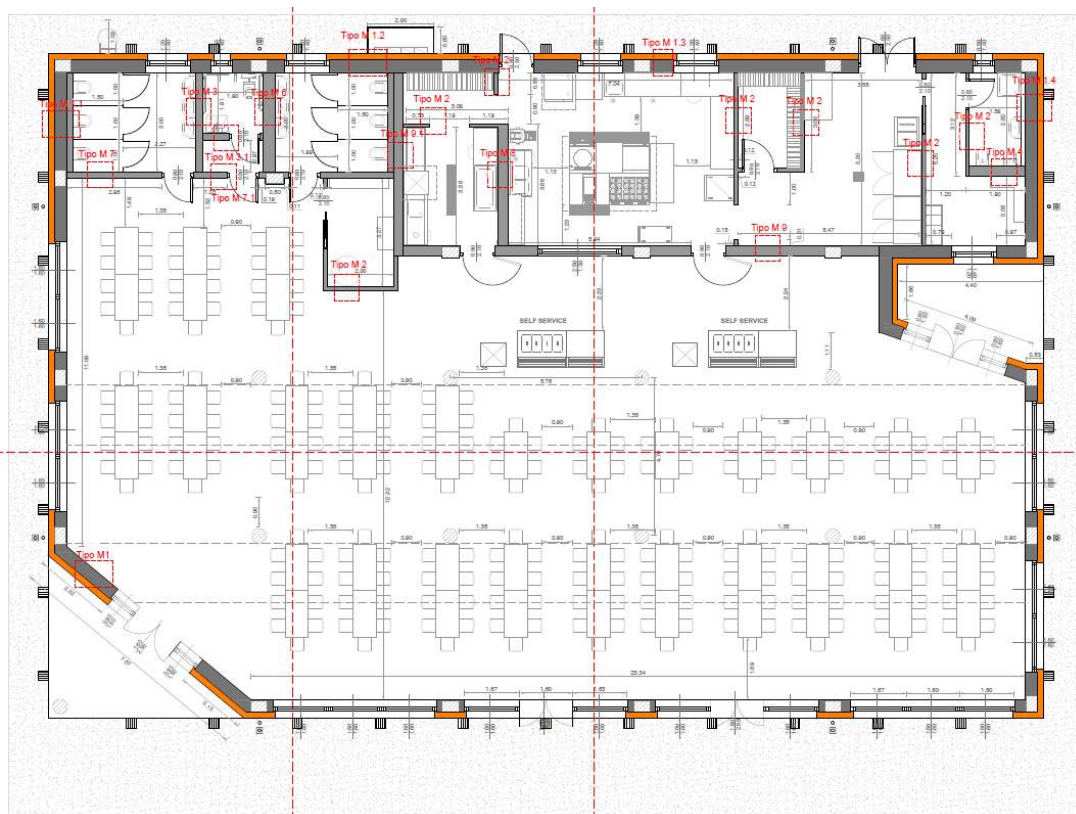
Pianta di progetto. Tav.04.1_Stato di progetto_Pianta e dettagli
